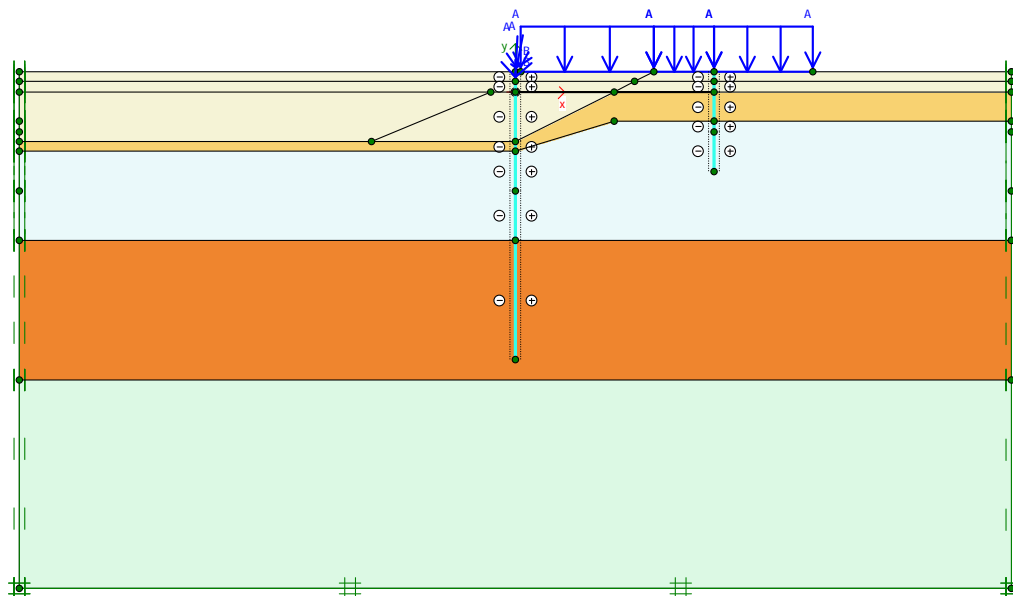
Sezione di calcolo C-C spalla destra con Plaxis
